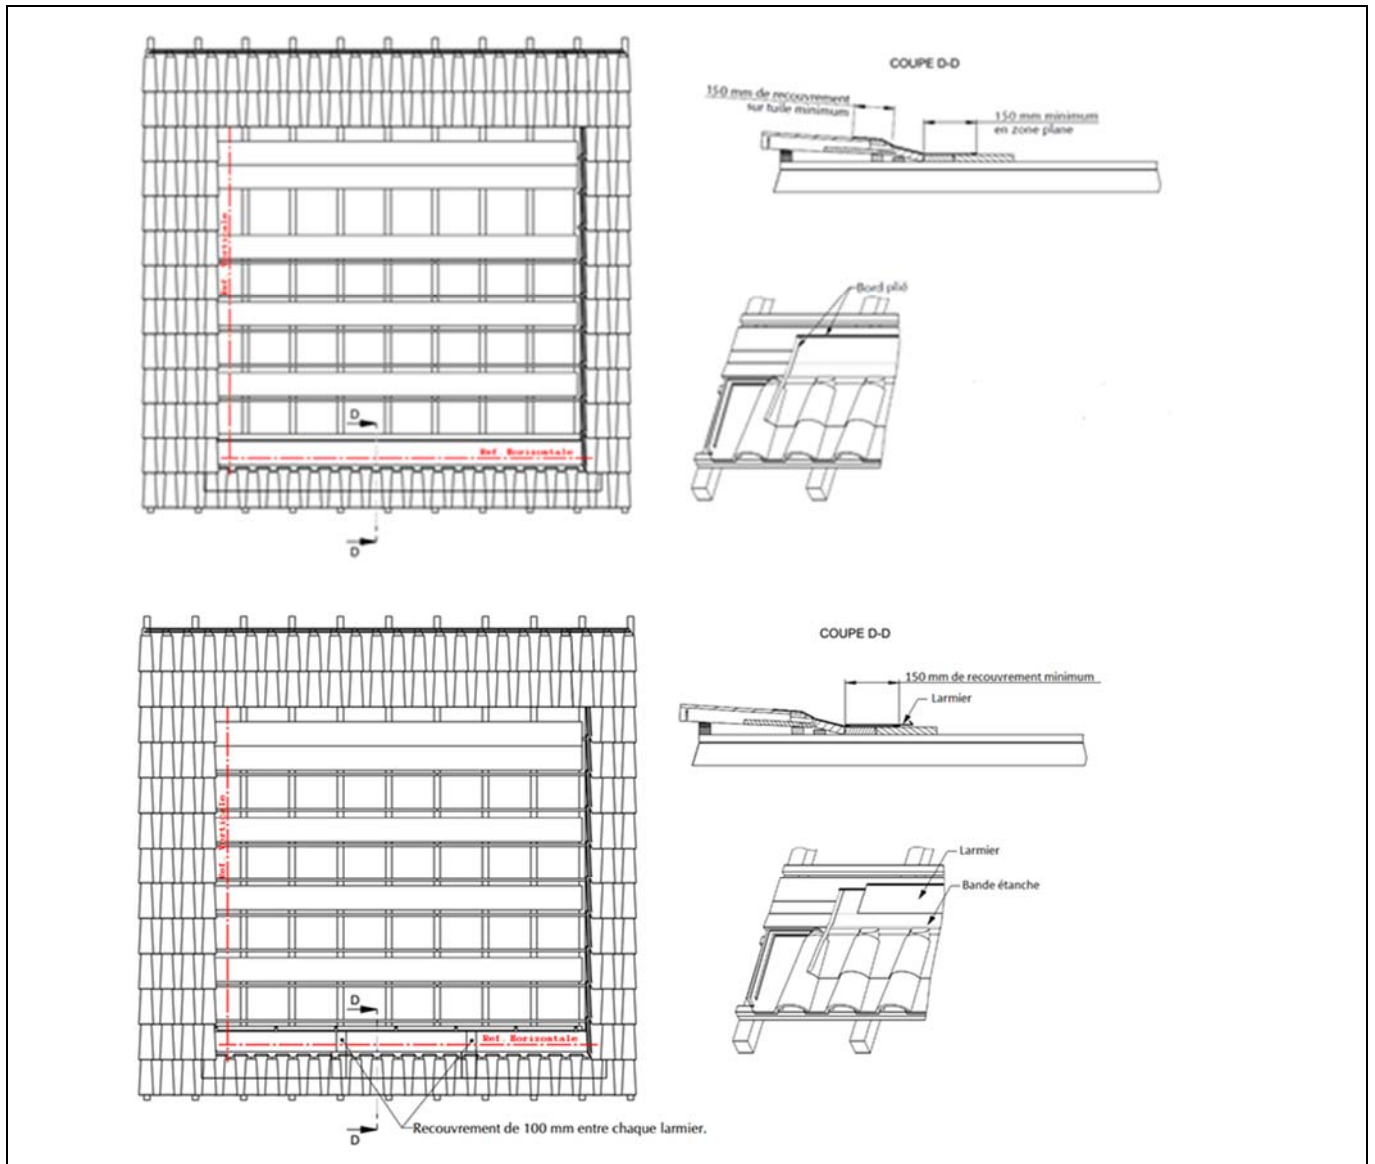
Pose des larmiers inférieurs pour installation sur toiture ardoise
